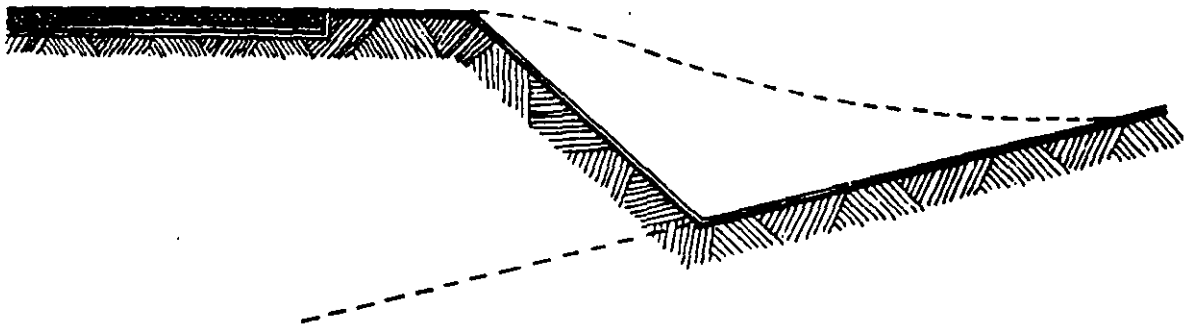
MENOR PENDIENTE EN TERRAPLENES
